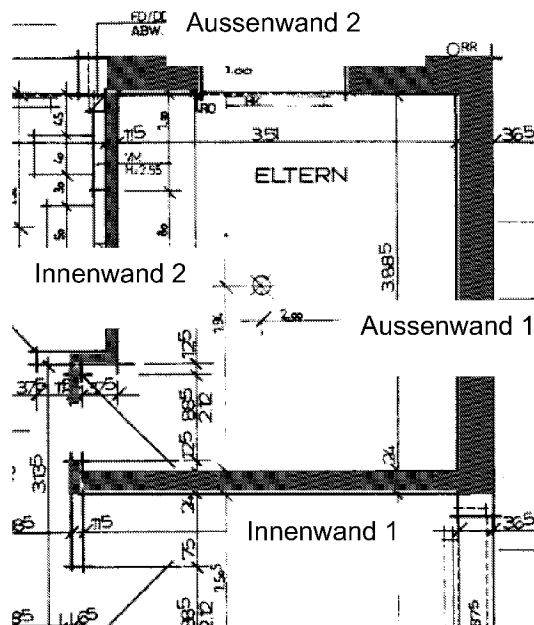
Grundriss des Demonstartionsobjektes
